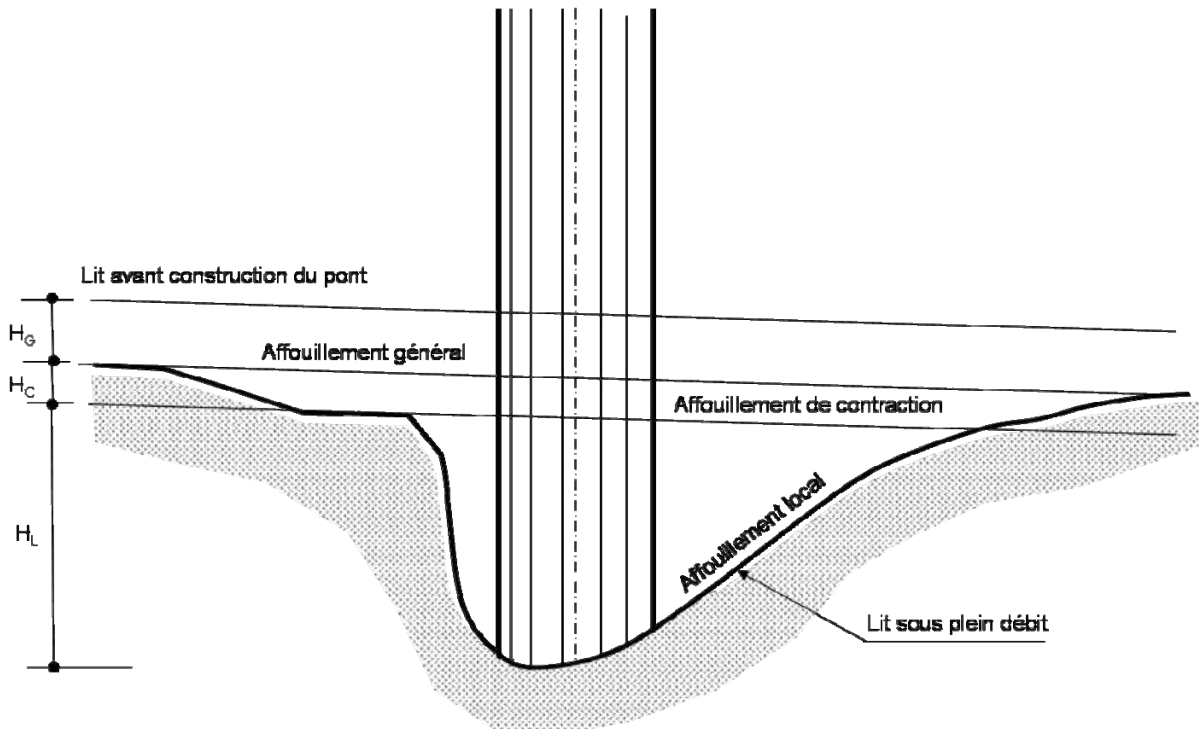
Les trois types d'affouillement au droit d'une pile d'un pont (d'après Van Tuu, 1981).
